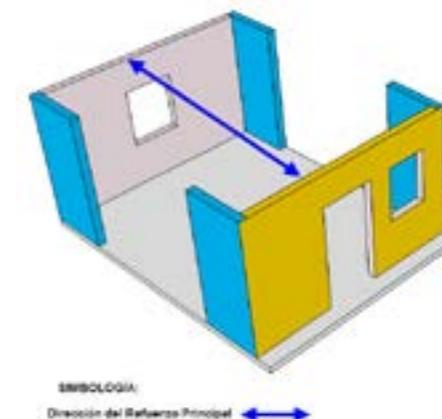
Vanos donde se colocarán vigas por falta de muros
